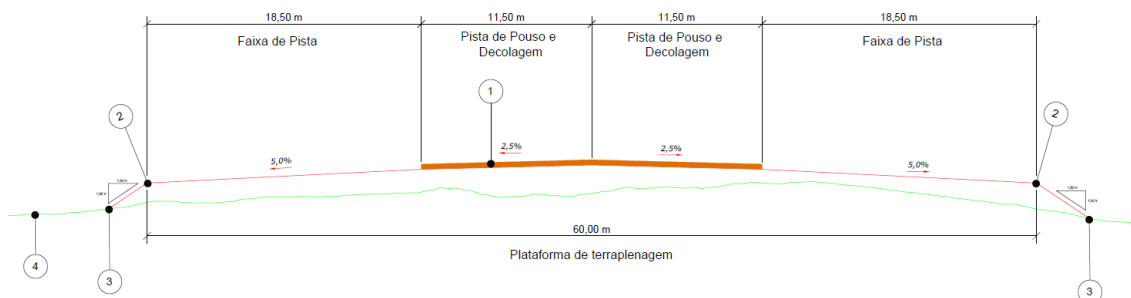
Seção Transversal Tipo de Terraplenagem em Aterro - PPD (Fonte: INFRAMS)
